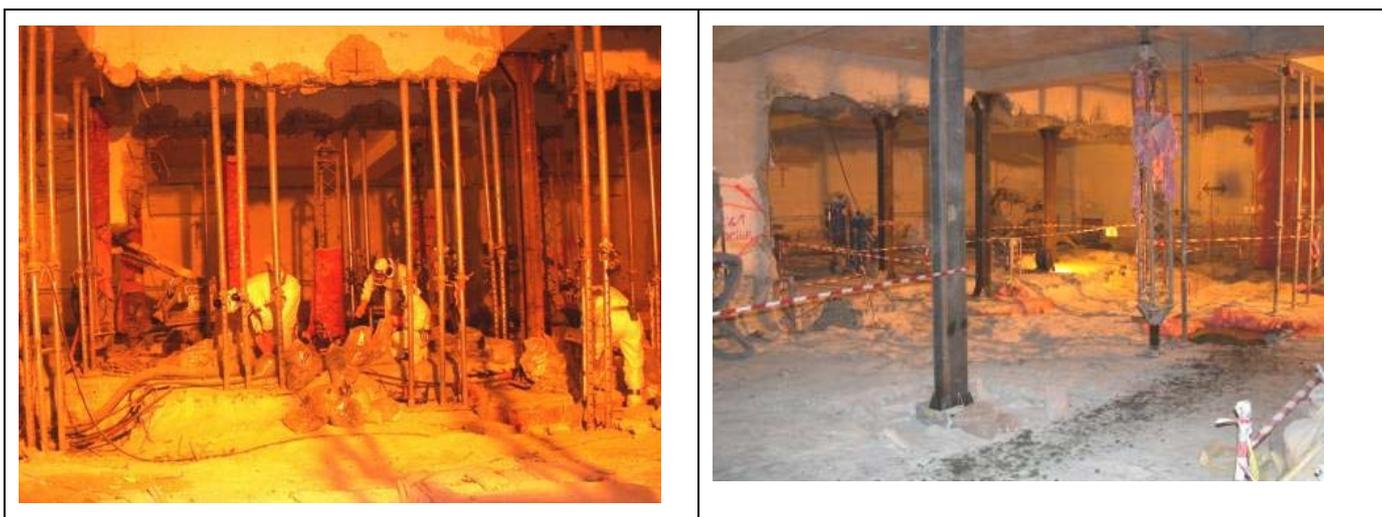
Brennilis, chantier pilote assainissement des infrastructures de la STE
